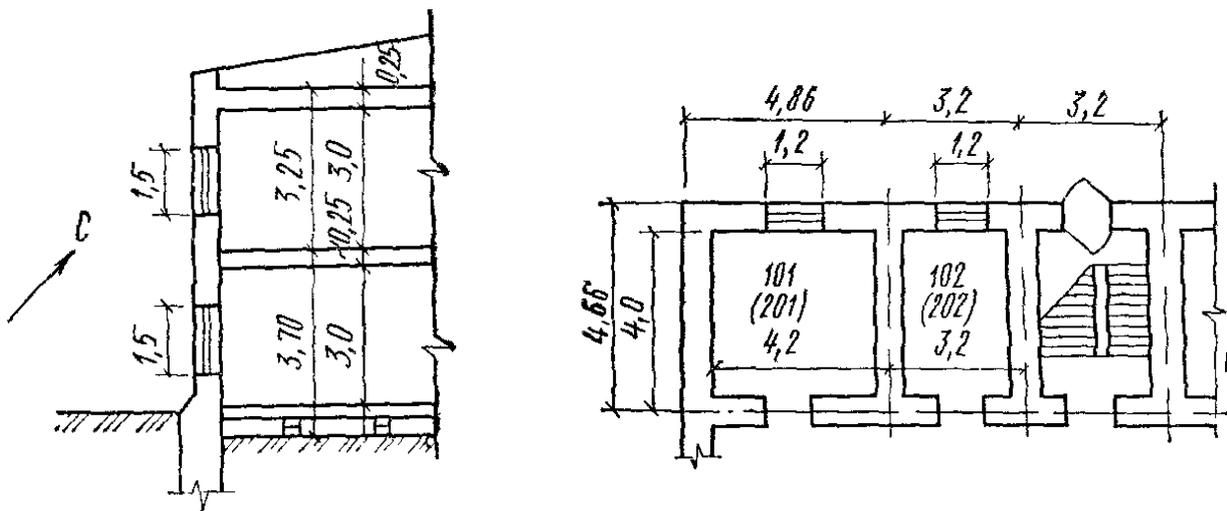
План и разрез помещений (к примеру расчета расхода тепловой энергии)
